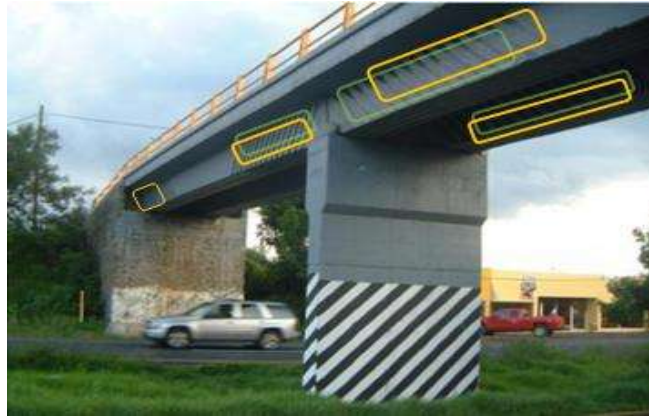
Puente reforzado con laminas inclinadas de fibra de carbón (Jara y Jara, 2010).
